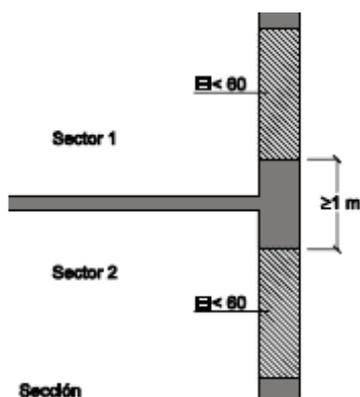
Encuentro entre losa – fachada fachada con saliente
